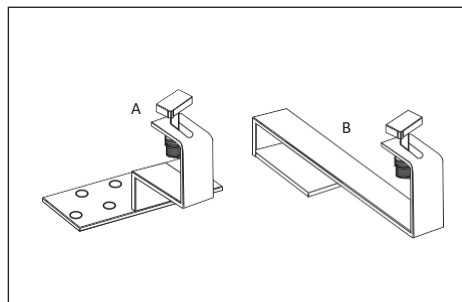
Dachhaken (A) – Befestigung direkt am Sparren; Dachhaken (B) – Befestigung an Montagebrett.
